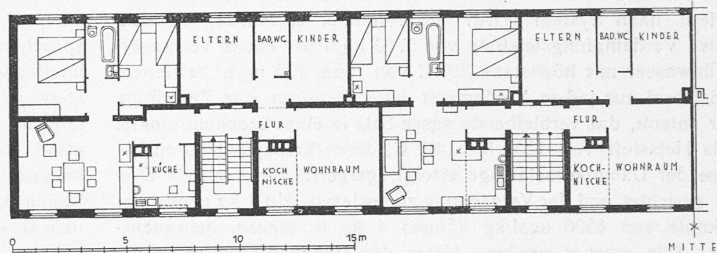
Grundriss-Typen des Ziegelmauerwerk-Baublocks. — 1 : 300.
